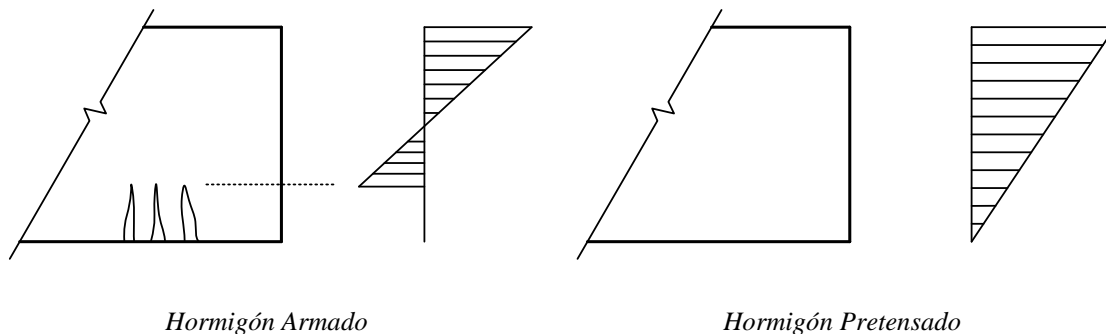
Esquema de tensiones de una sección de Hormigón armado y otra de Hormigón pretensado.
